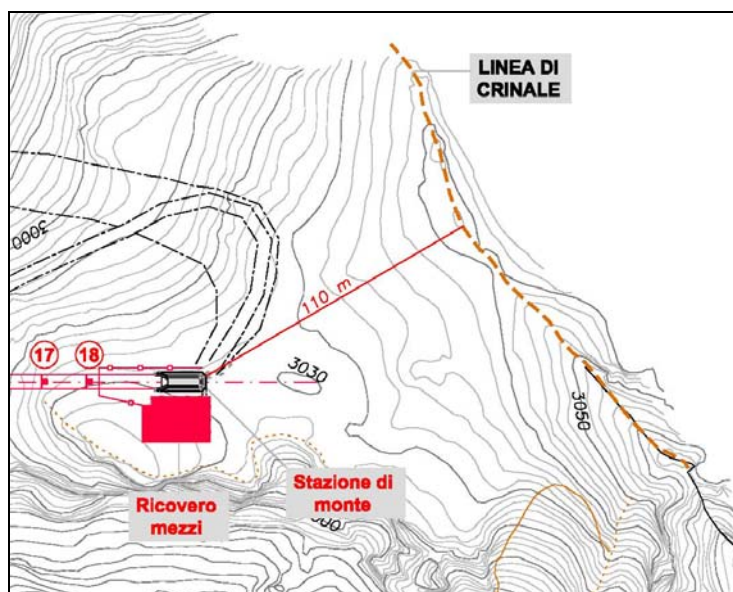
/2 Collocazione degli edifici rispetto alla linea di crinale
